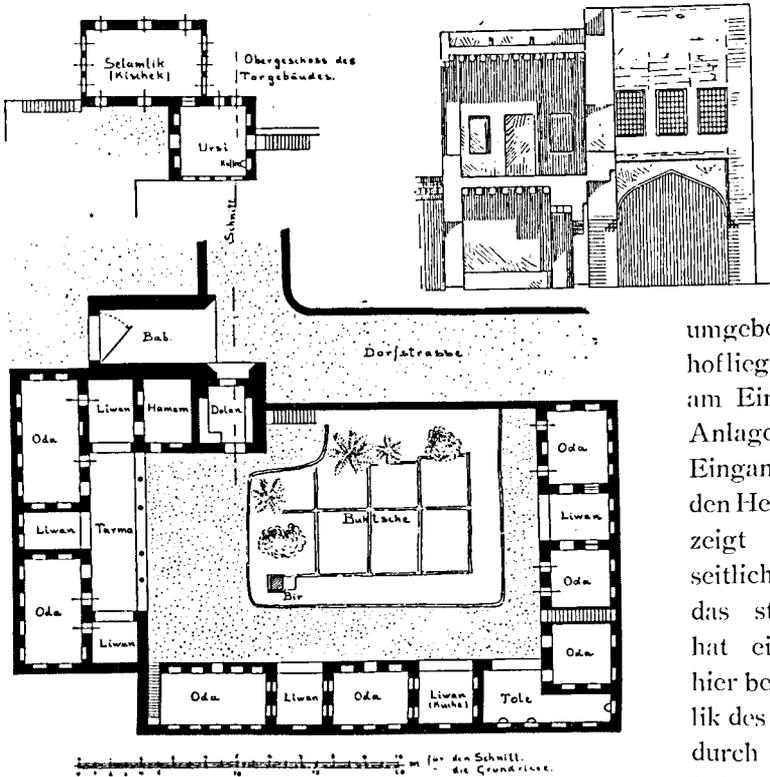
Haus des Abdallah Tschelıbi, Bernün, Grundriß u. Schnitt.
